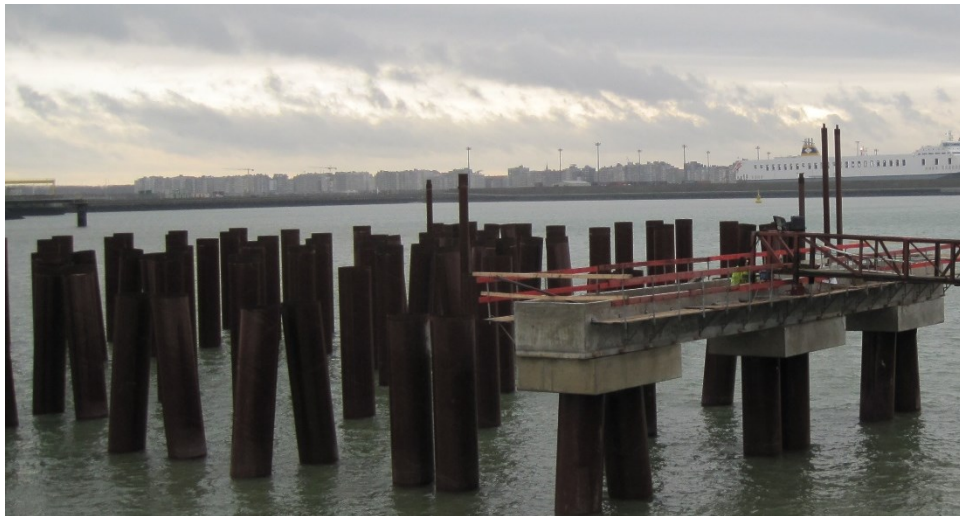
Beispiel einer Anlegerstruktur mit Plattenbalkendecke aus Stahlbeton
